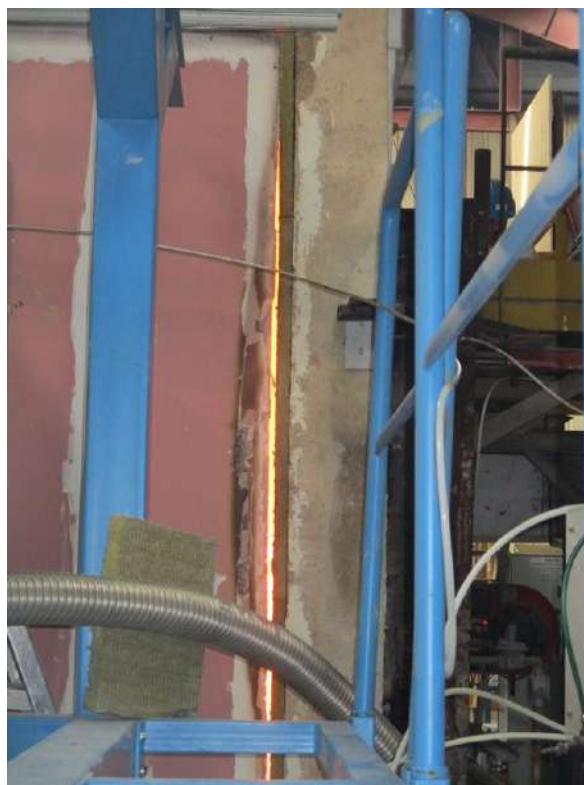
Photo G (haut)	Vue de la cloison flexible en longueur non exposée après 71 minutes d'essai feu.
